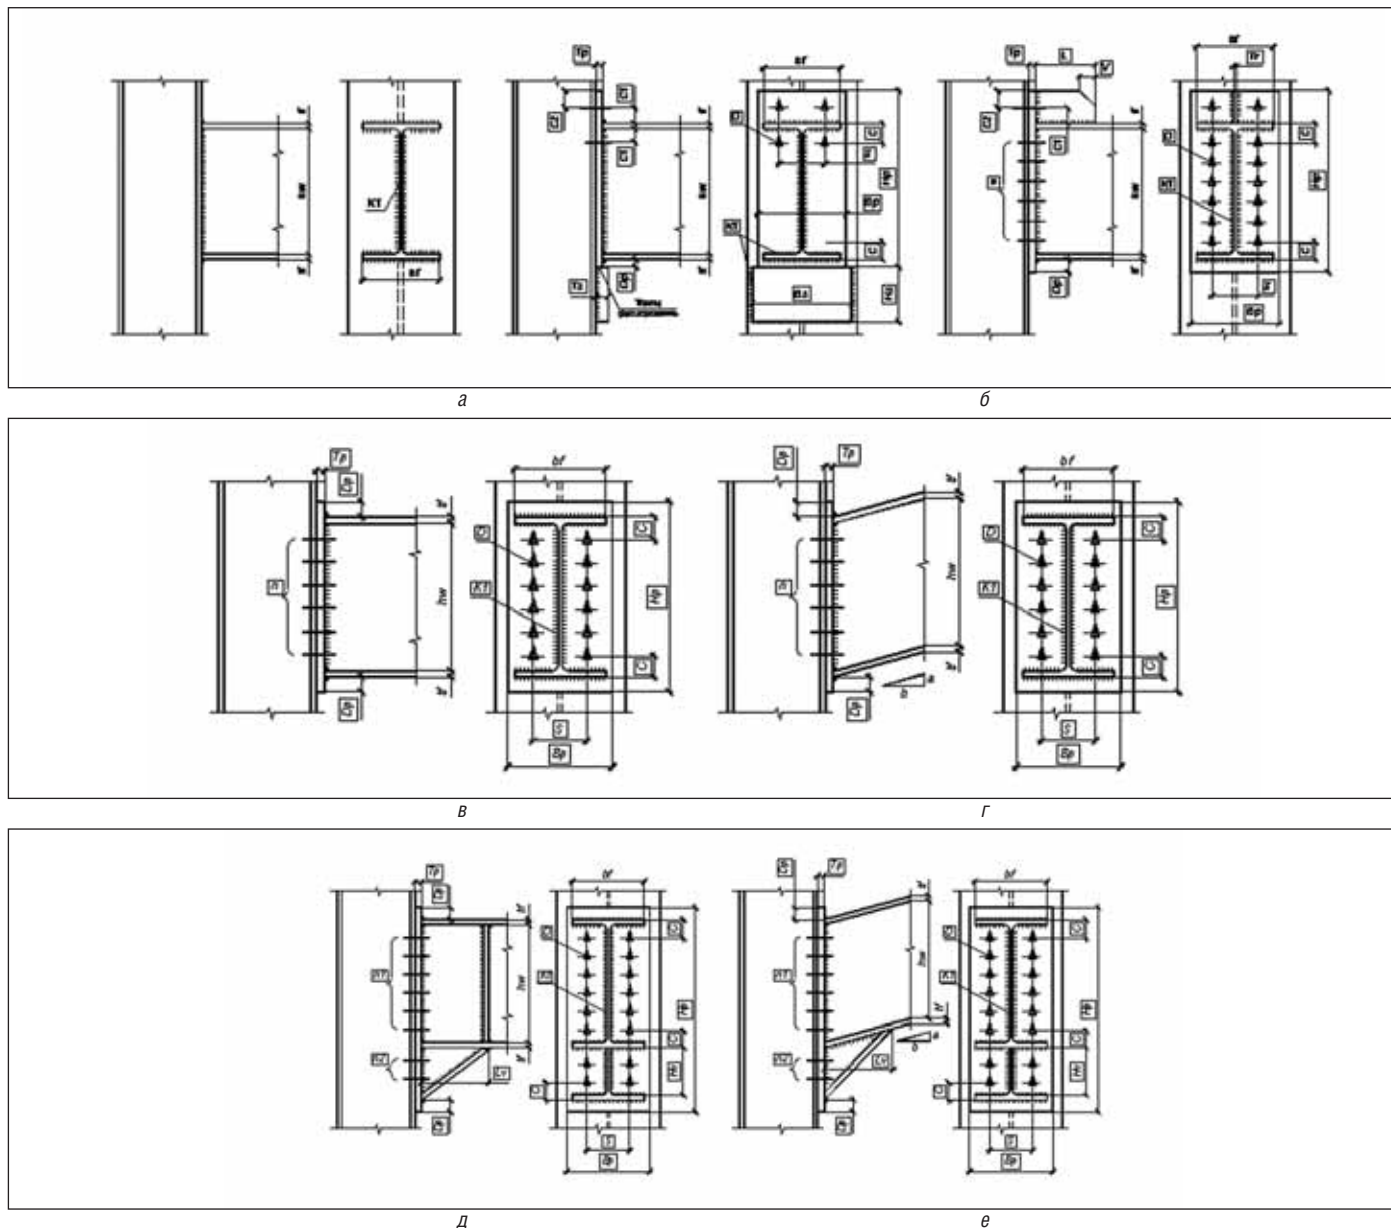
Типы конструктивных решений узлов жесткого сопряжения ригеля с колонной с использованием фланцевых соединений
